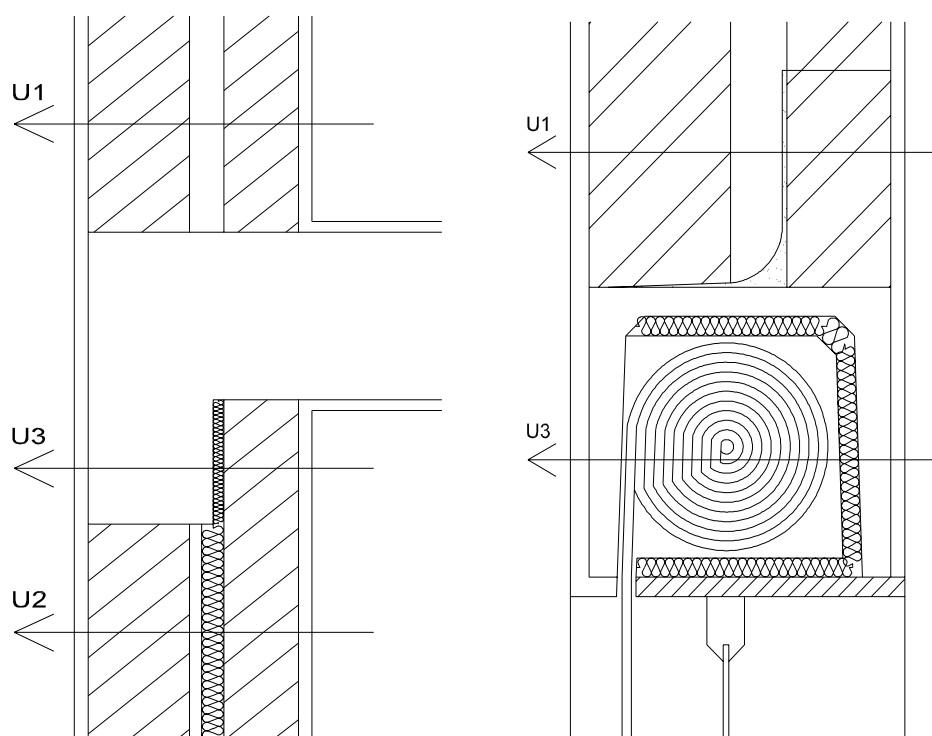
Pontes Térmicas Planas – Talão de Viga e Caixa de Estore
